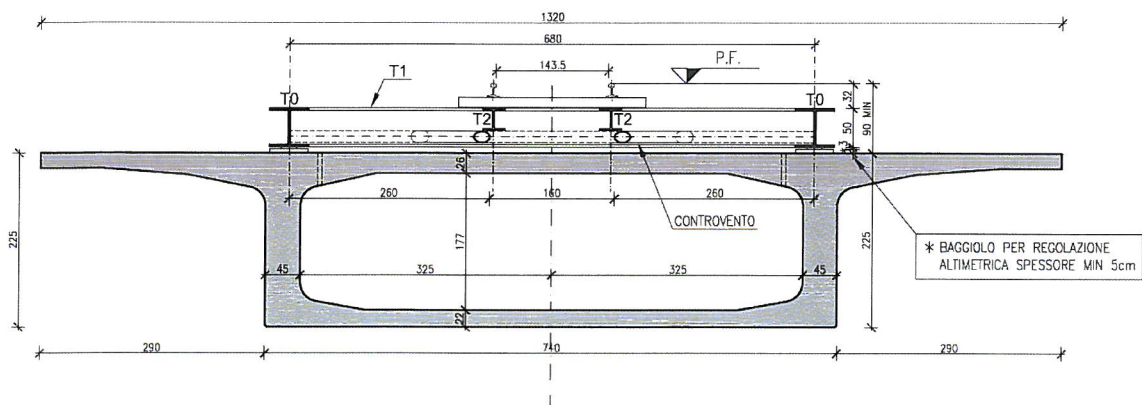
Sezione tipo impalcato attraversamento provvisorio A32
